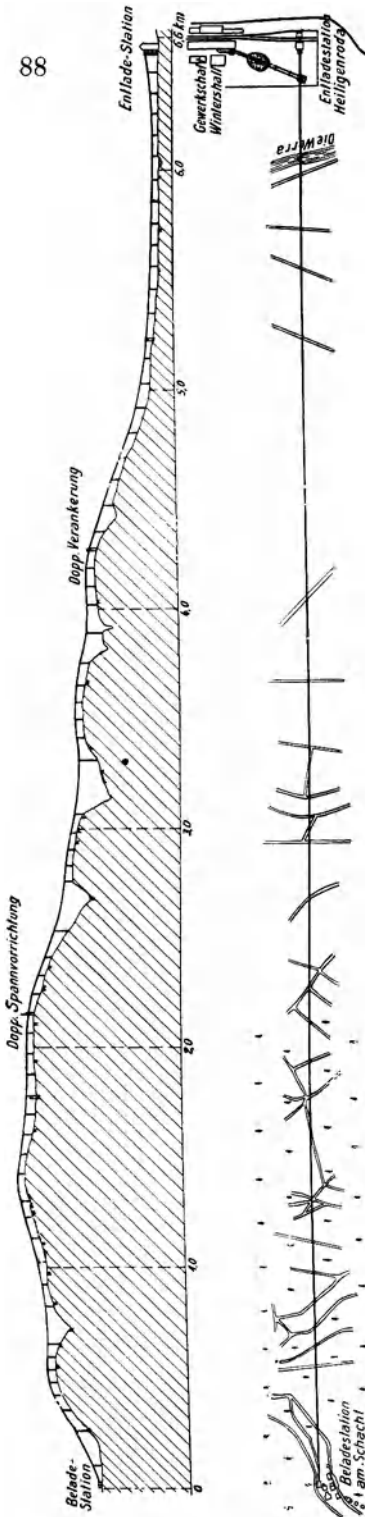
Längsprofil und Lageplan der Drahtseilbahn Heiligenroda (Bleichert).
